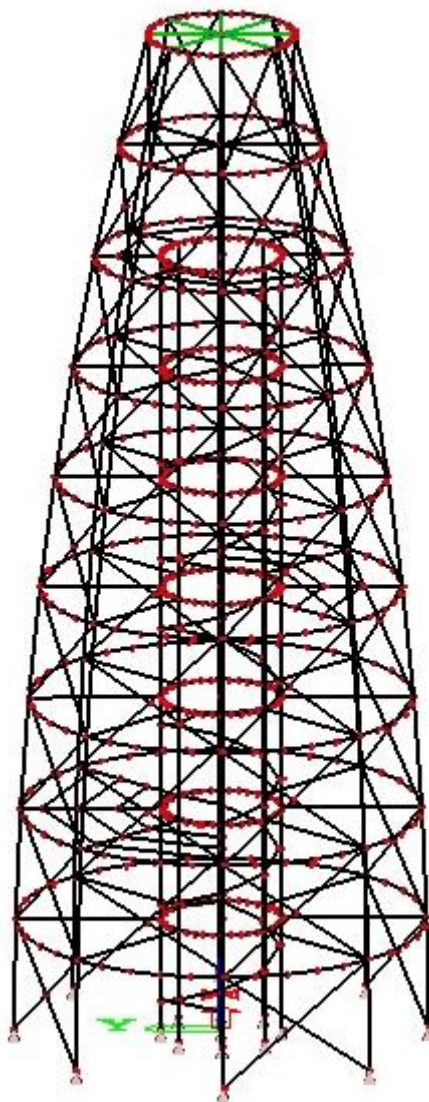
Schéma konstrukce a půdorysy vyhlídkových plošin
